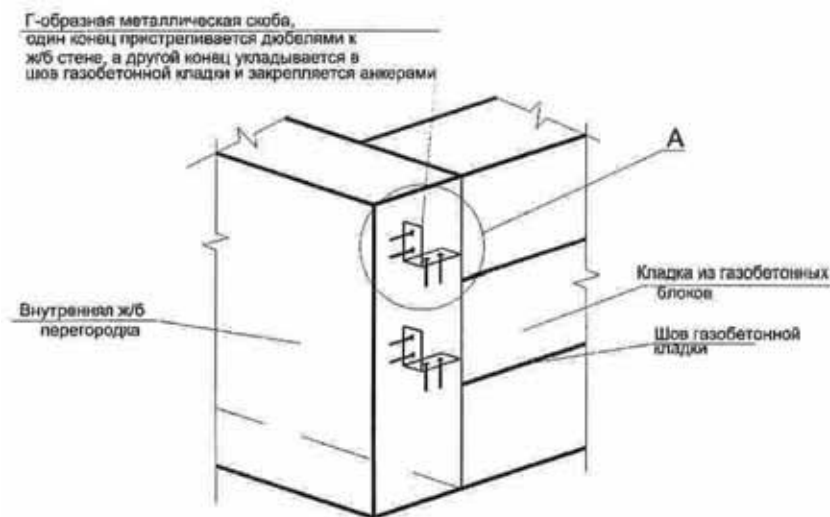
Схема расположения механических связей в кладке стен из газобетона
